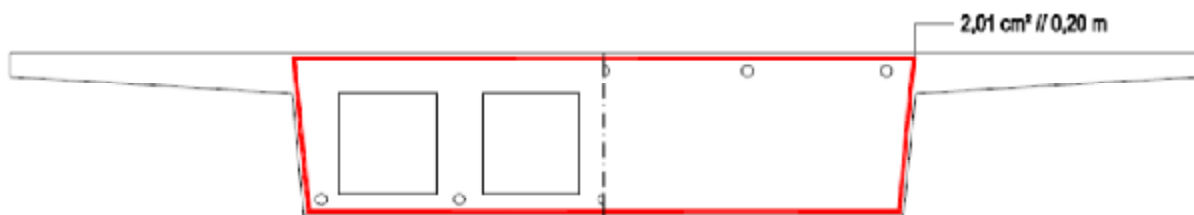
Esquematisação das armaduras transversais de torção para todas as secções do tabuleiro
